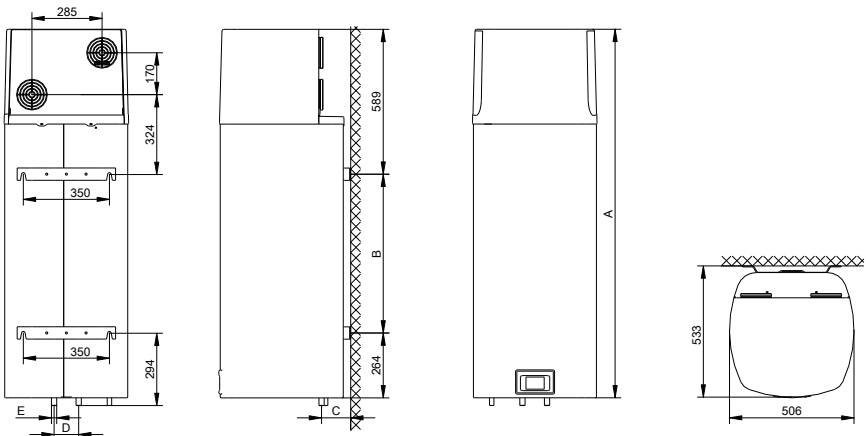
Anschluss- und Installationsmaße der Wärmepumpe (mm)
